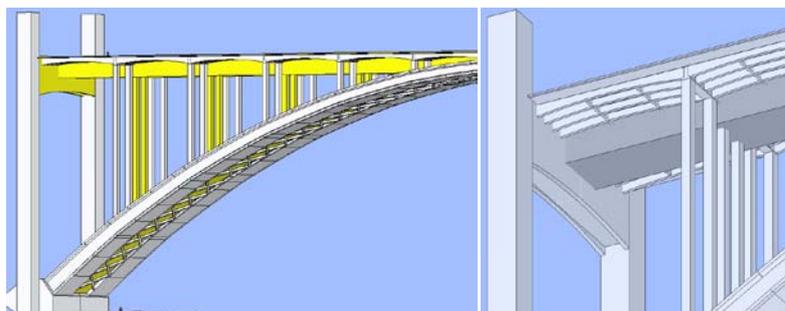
Vistas da solução em viga caixão (solução adoptada)
